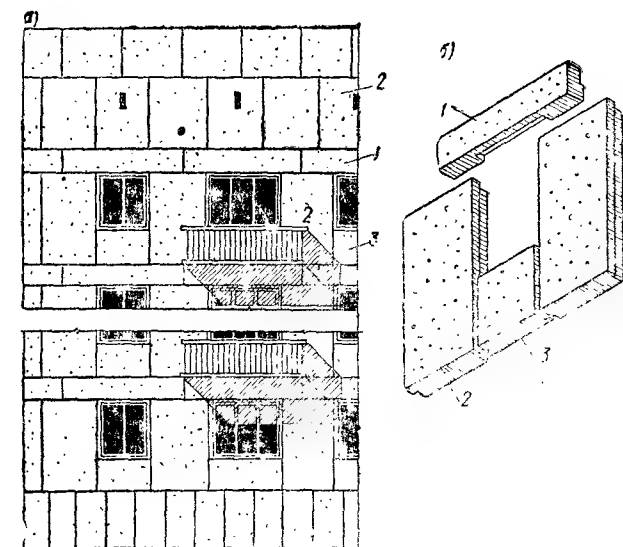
Разрезка наружных стен и детали несущих конструкций 12-этажного крупноблочного дома с чердаком
